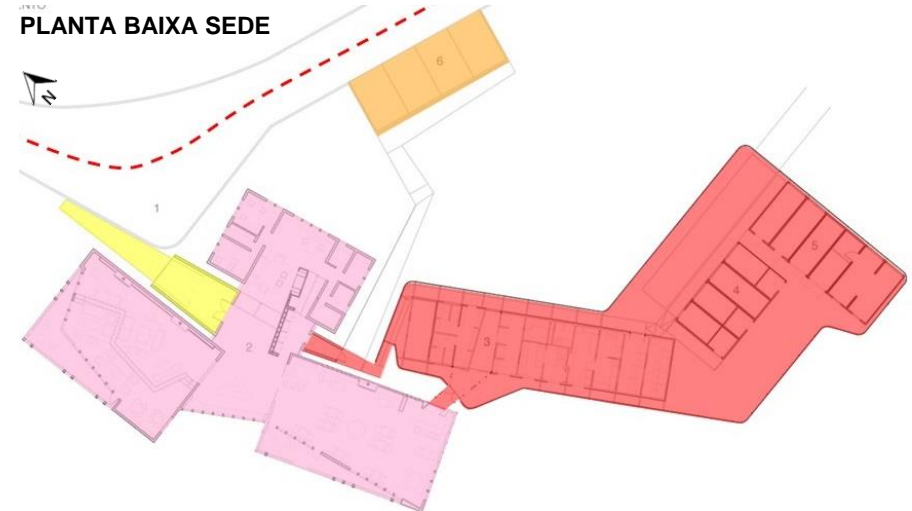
| Fonte: ARCHDAILY, 2015b. EDIÇÃO AUTORA.
